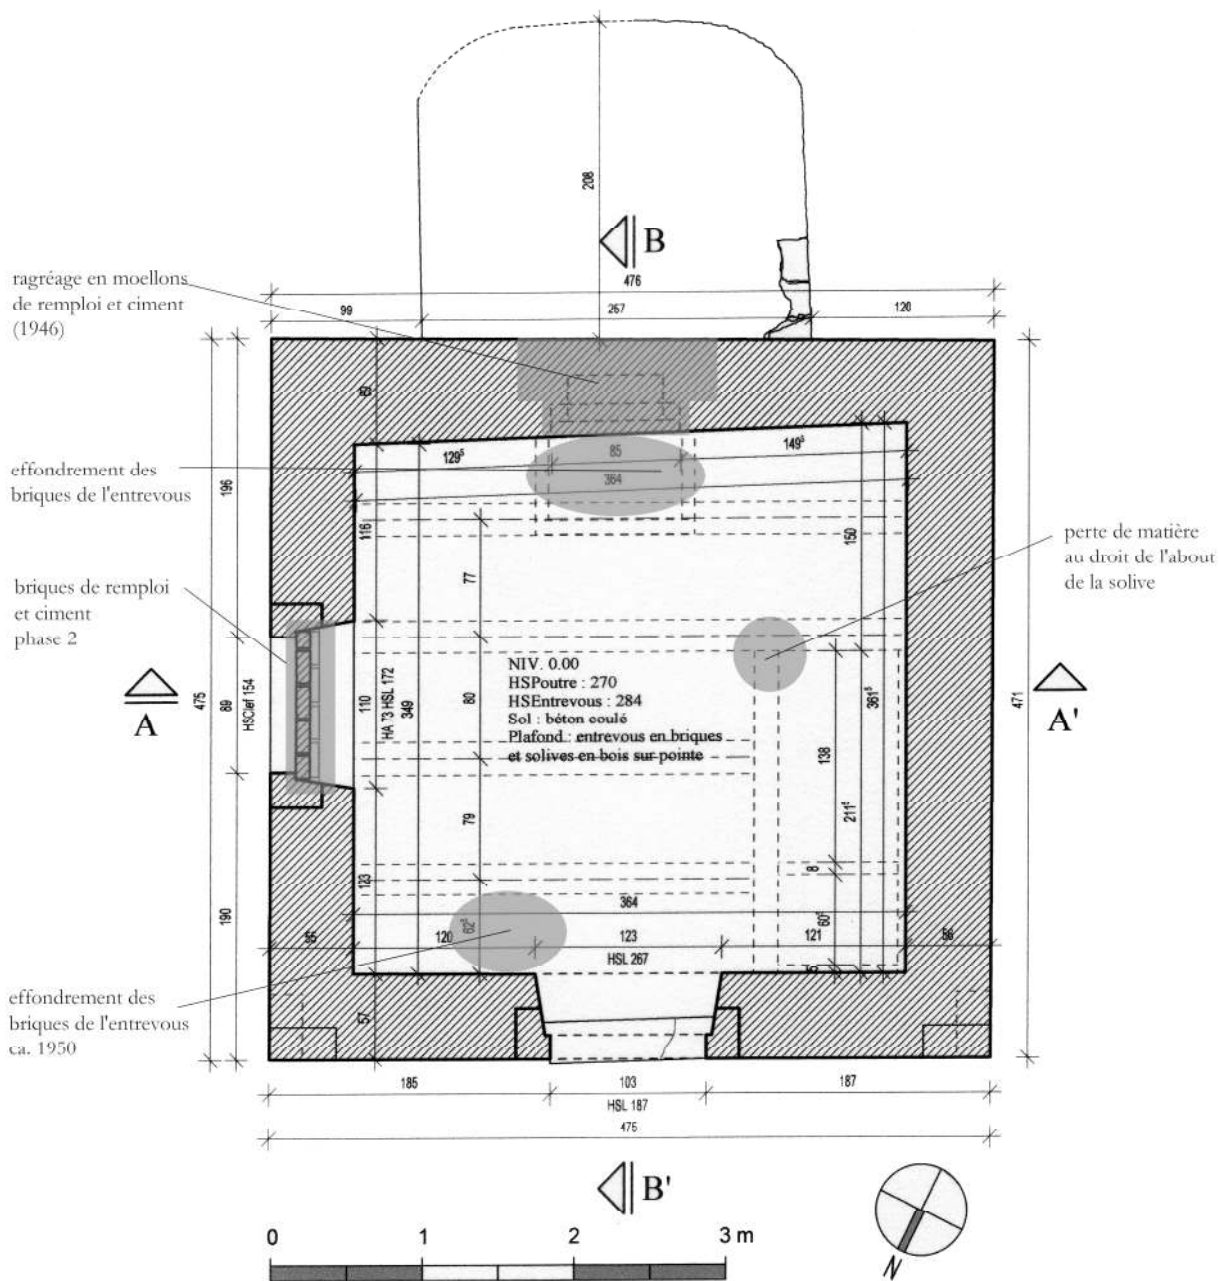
Pavillon et four. Vue en plan rez-de-chaussée. Ech. 1/50^e. Etat sanitaire. IG 2008.
